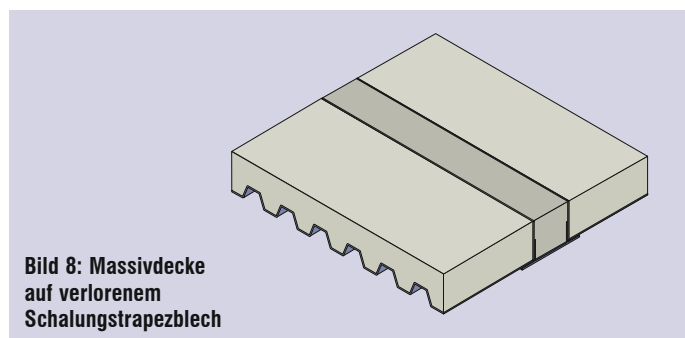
Massivdecke auf verlorenem Schalungstrapezblech
